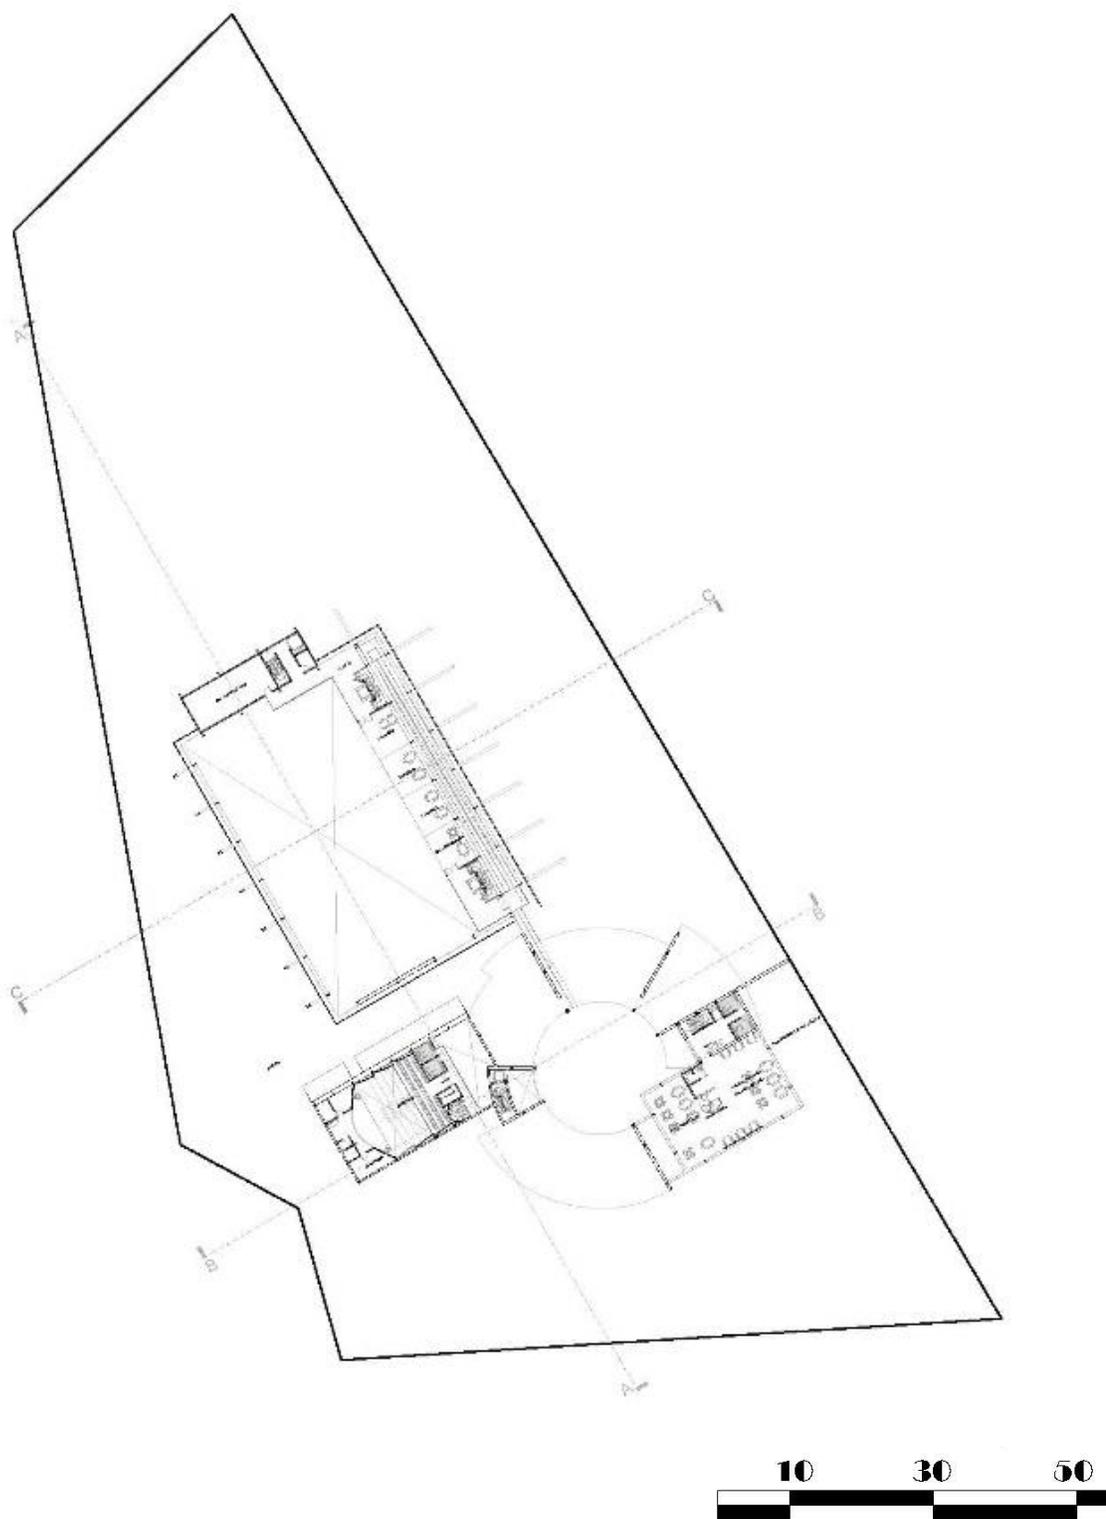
Planta Nivel 2- CCDEL- Elaboración propia.
